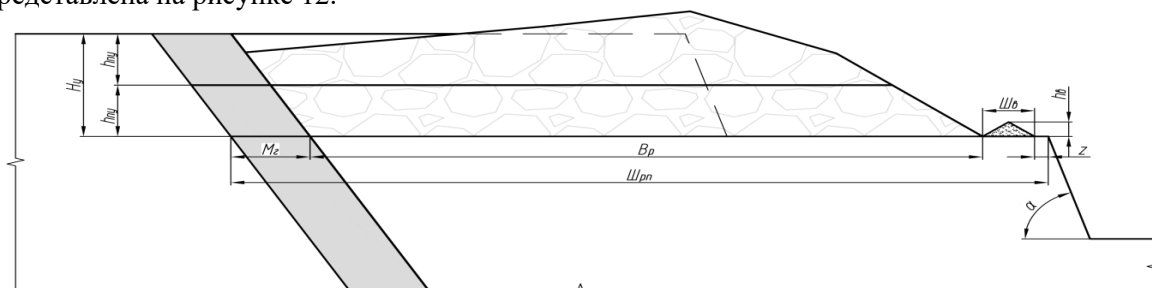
Схема расчета ширины рабочей площадки при отработке угольного пласта
